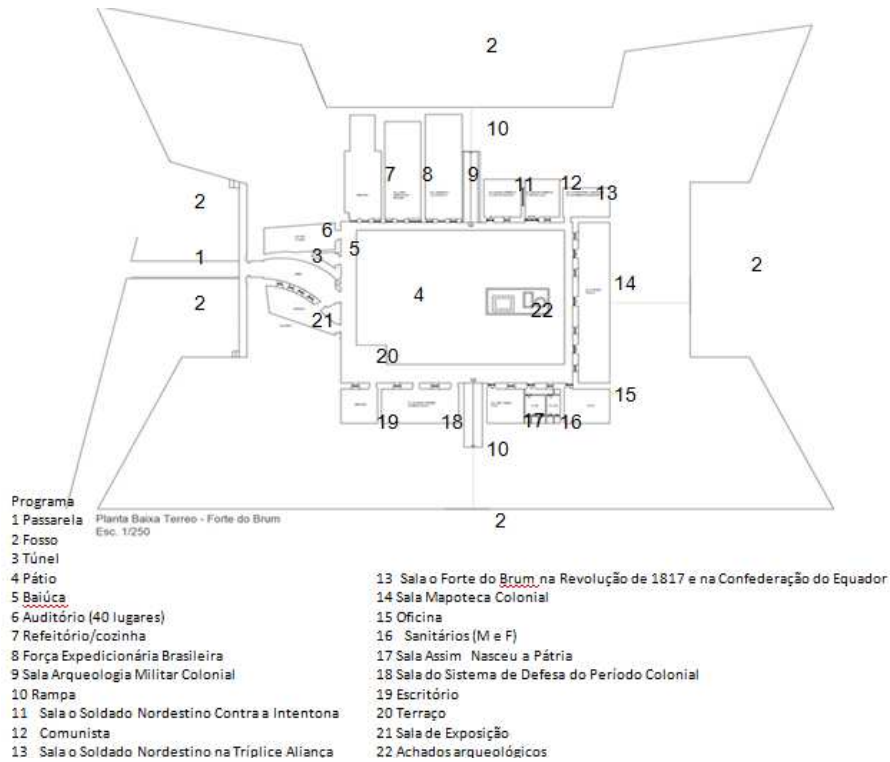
Usos do pavimento térreo – Praça de Armas do Forte do Brum
